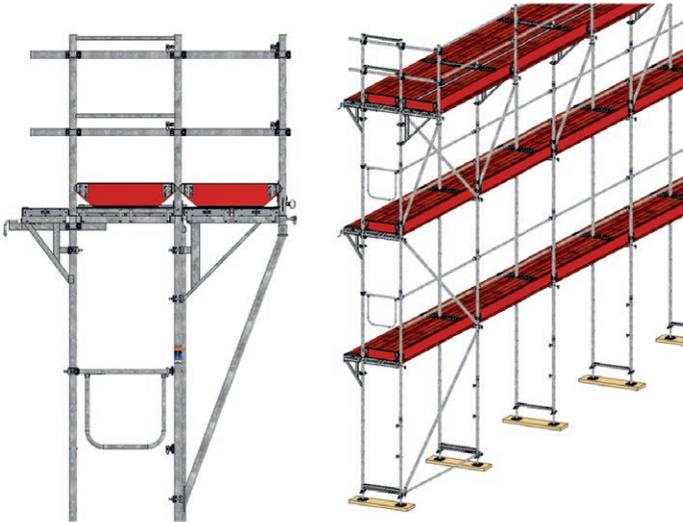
Леса с наружными расширяющими кронштейнами на два элемента настила и подкосом
